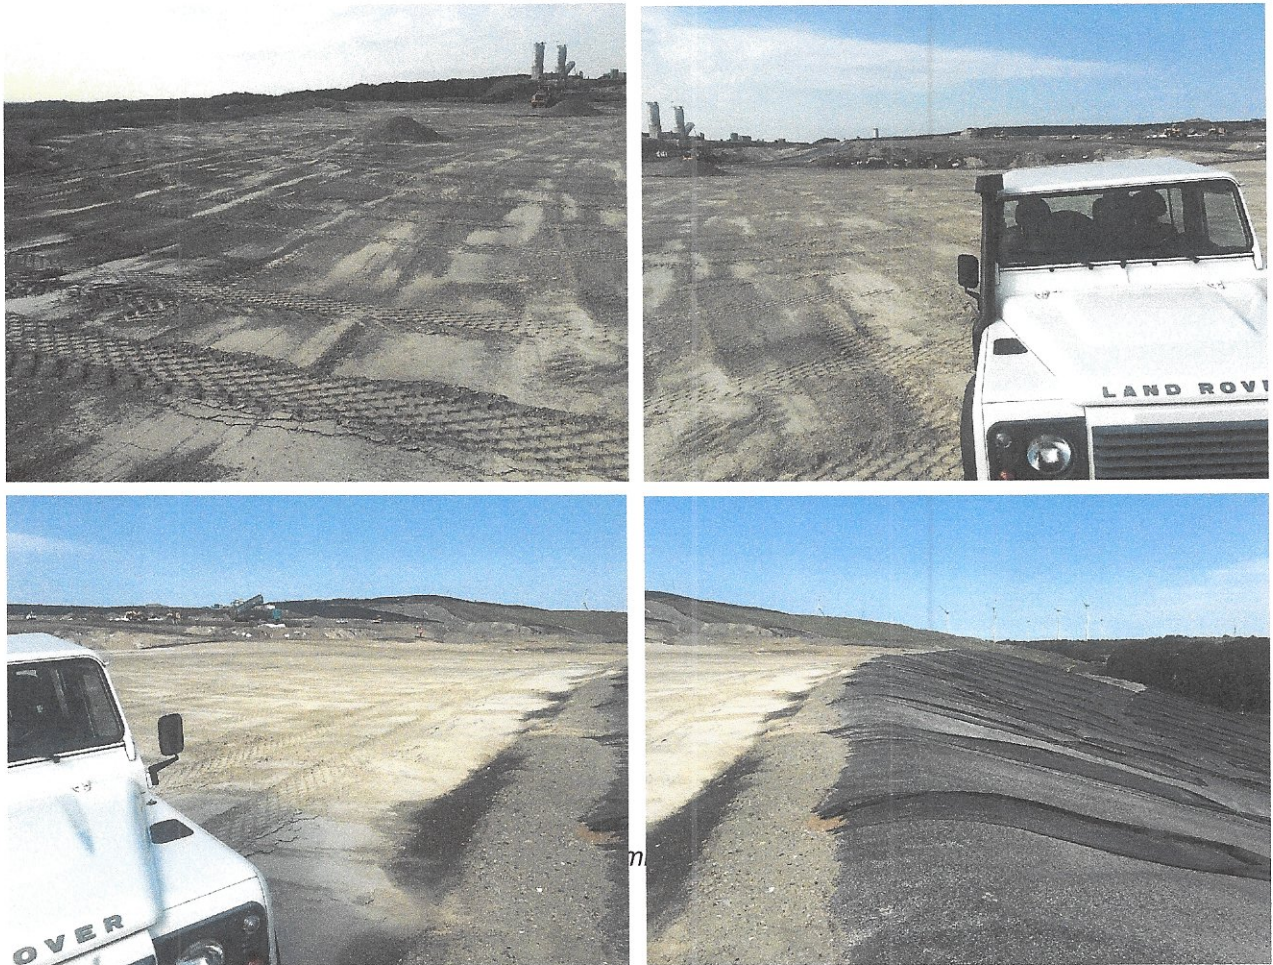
Ablagerung auf dem Plateau im BA 8, oberes Niveau (September 2020)
